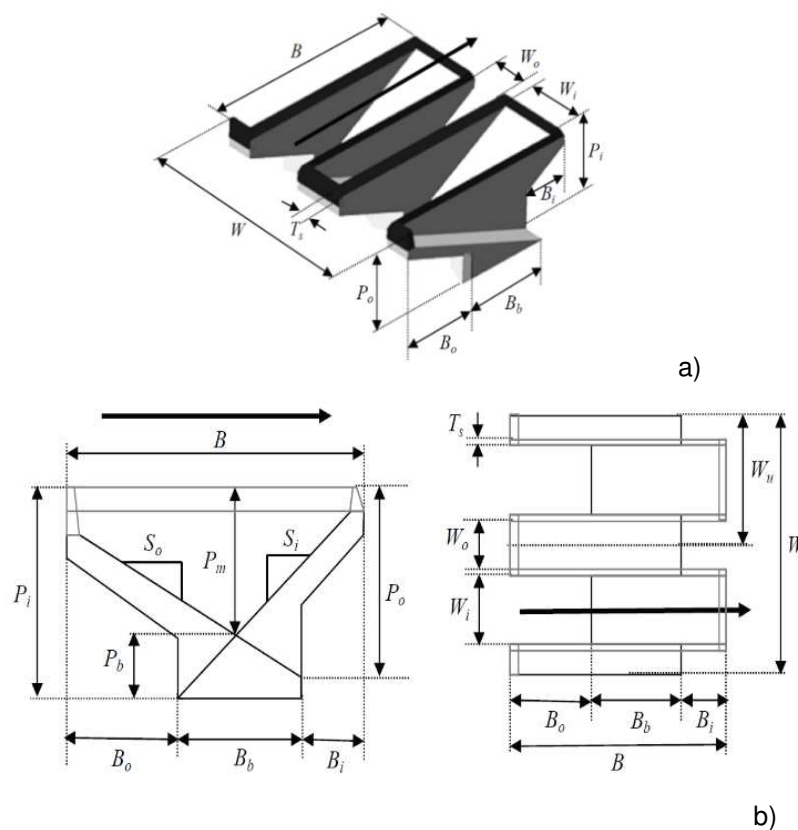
| Principais grandezas de uma soleira descarregadora em teclado de piano: a) vista 3D; b) perfil e planta (adaptado de Pralong et al., 2011)
